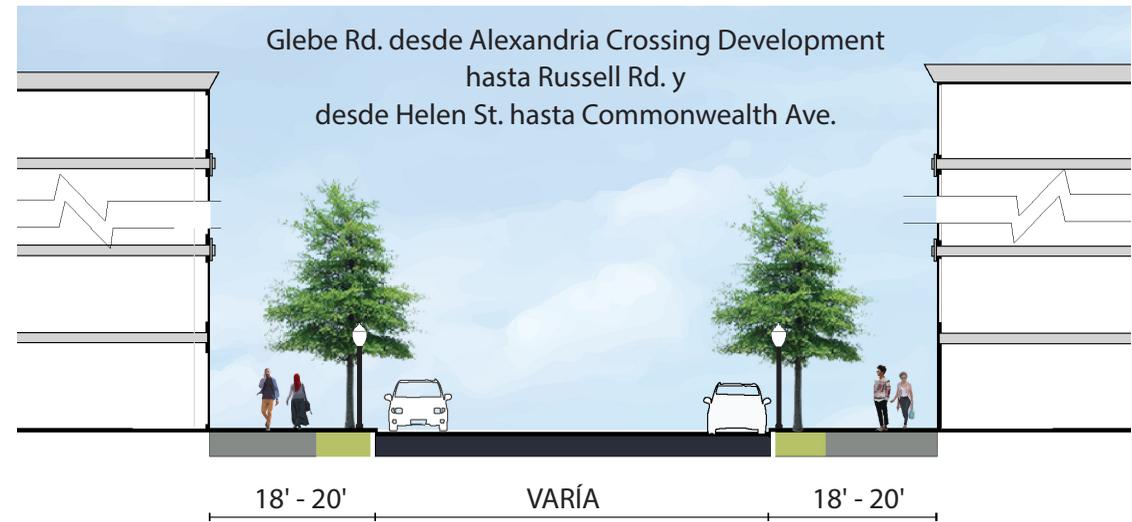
Sección típica de Mount Vernon Avenue/Glebe Road
